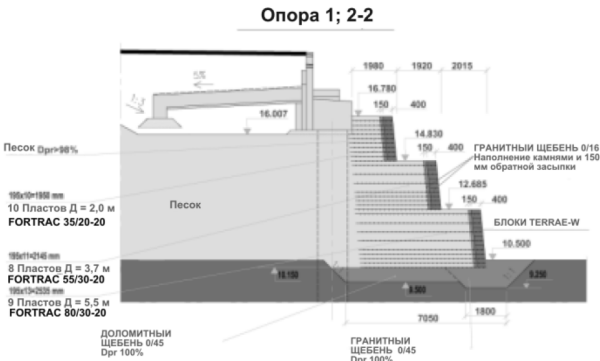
Поперечный разрез подпорной стены с наружной стеной из армированного грунта, „Via Baltica”, Латвия [9]
